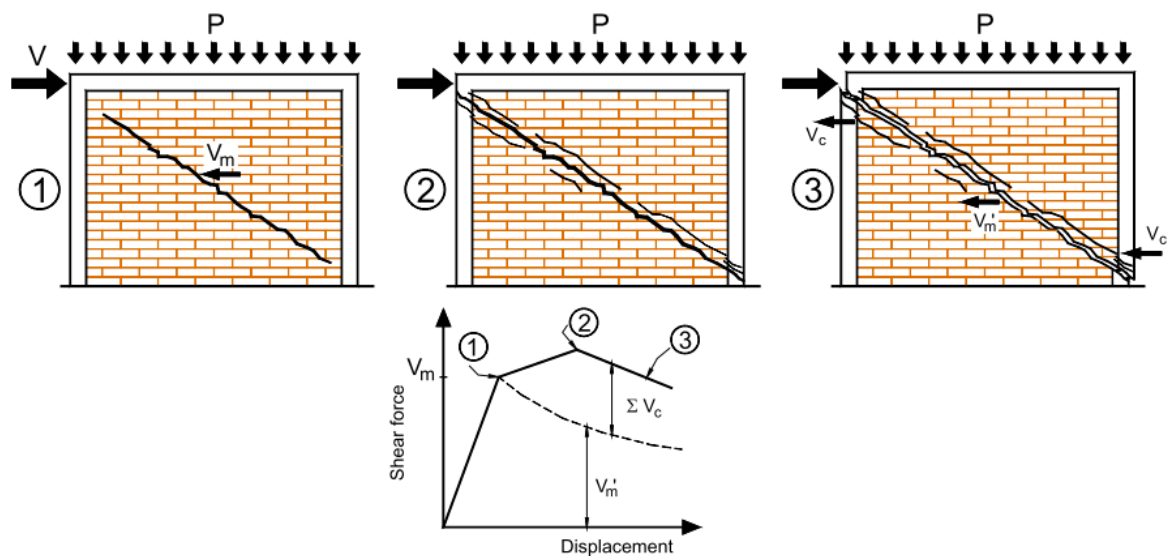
1) grietas diagonales en los PRM; 2) las grietas diagonales se han propagado desde la pared hacia las columnas de unión, y 3) la falla de corte de las columnas de unión y la pared de mampostería. Fuente: (Brzev & Meli, 2010)
